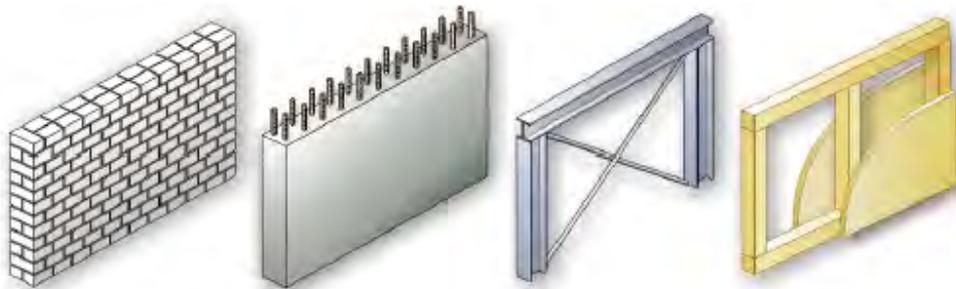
Im Bau übliche Materialien und Bauweisen für ein statisch aussteifendes Bauteil. Von li. nach re.: Mauerwerk, Stahlbeton, Stahlrahmen mit diagonalen Aussteifungen, Holzrahmen mit OSB beplankt; Quelle: Tragwerkslehrer in Beispielen und Zeichnungen , Leicher - Werner Verlag.
